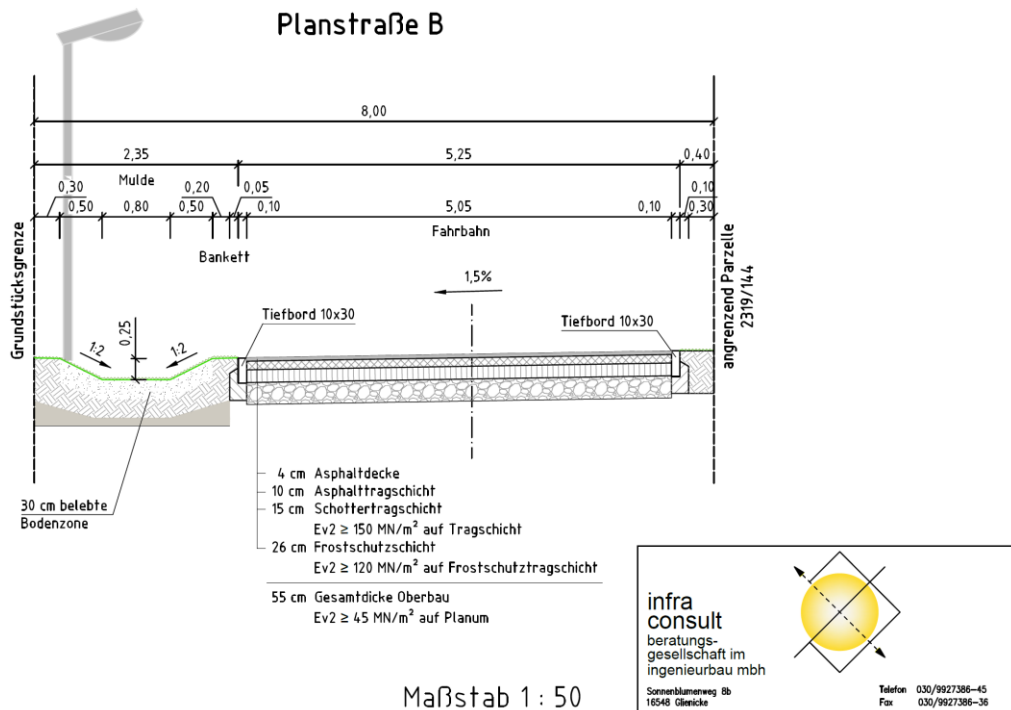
Geplante Straßenquerschnitte Planstraße B, C, D (Infraconsult Beratungsgesellschaft im Ingenieurbau GmbH, September 2025)
